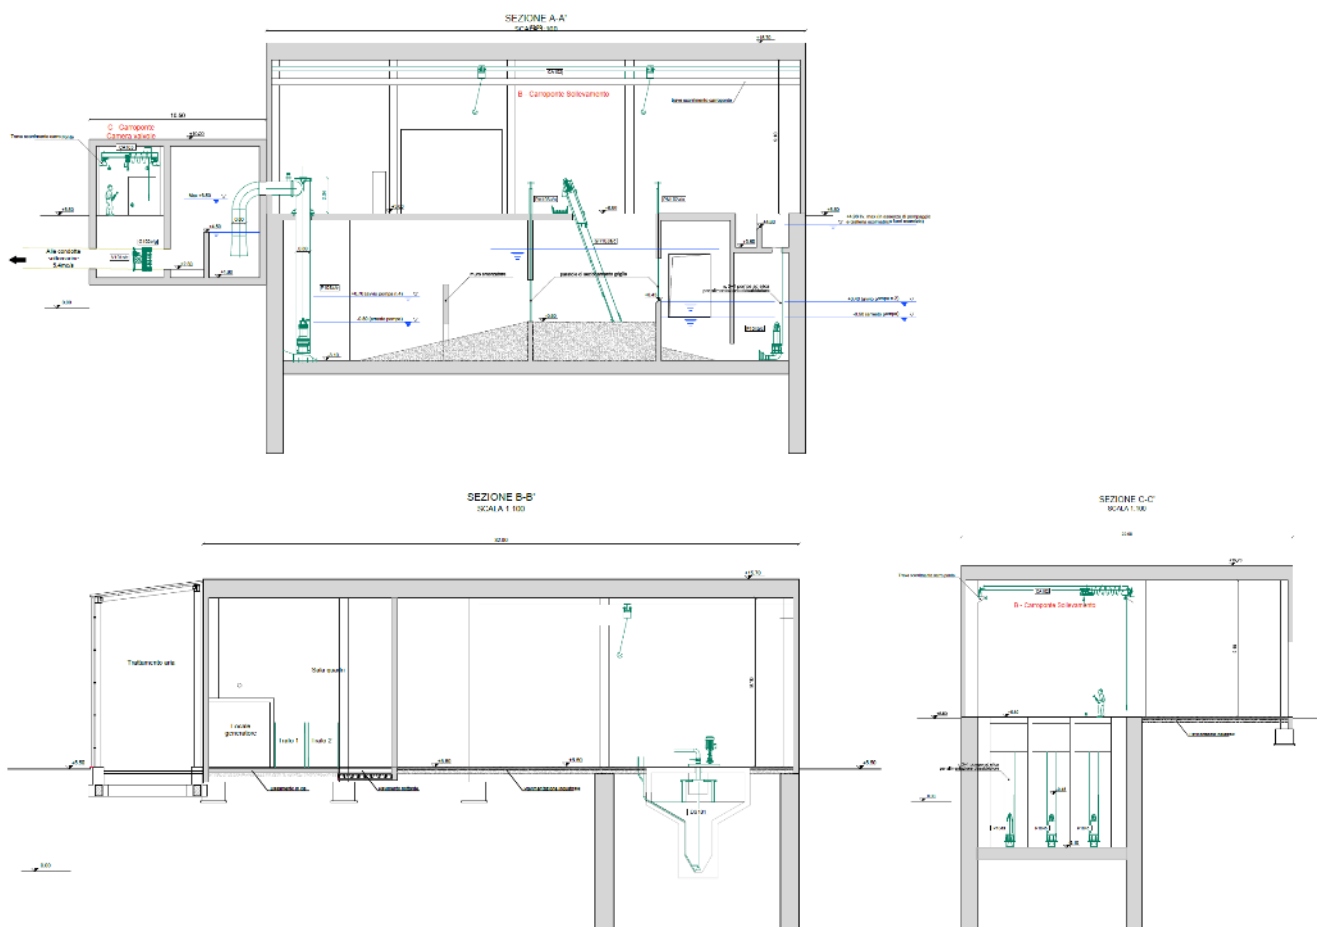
Nuovo impianto di sollevamento a mare e pretrattamento – Sezioni A-A, B-B e C-C
